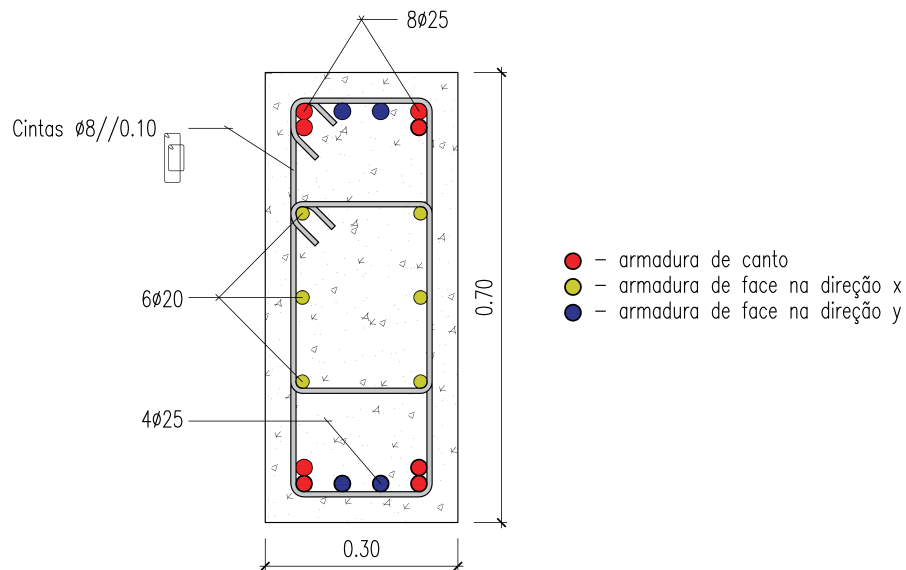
Pormenorização da secção do pilar P1-1.i do modelo base
